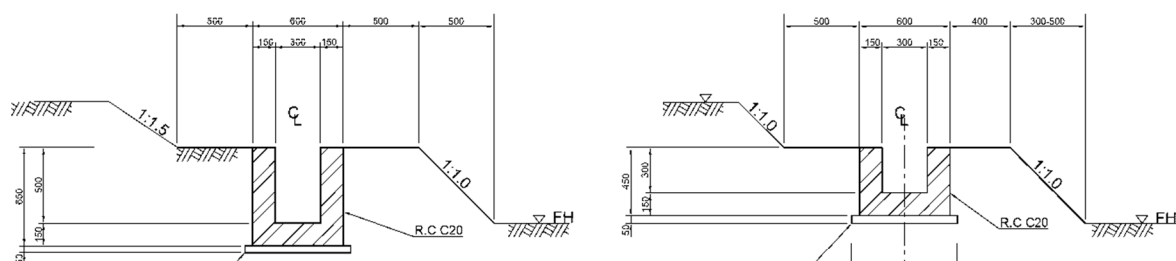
幹線用水路標準断面図(左)と二次用水路標準断面図(右)
